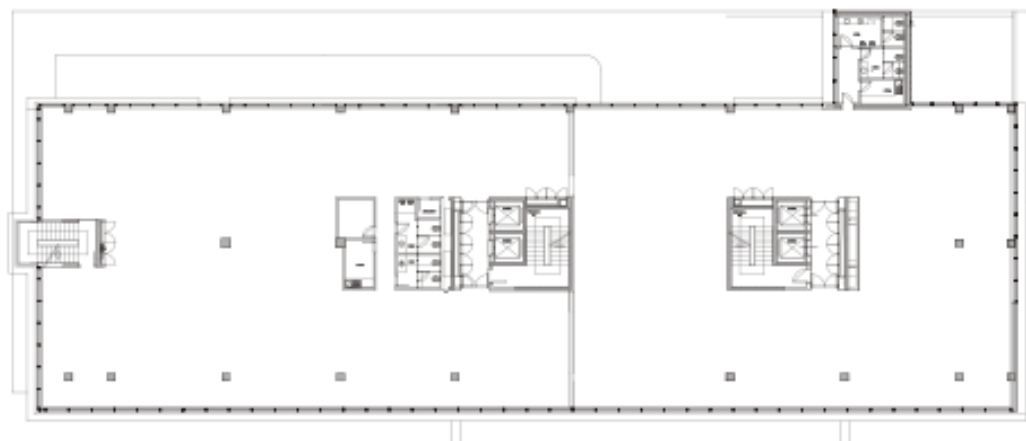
C - Exemplo de Construção do Tipo G [Macedo, Mário J. M. (2008)]
